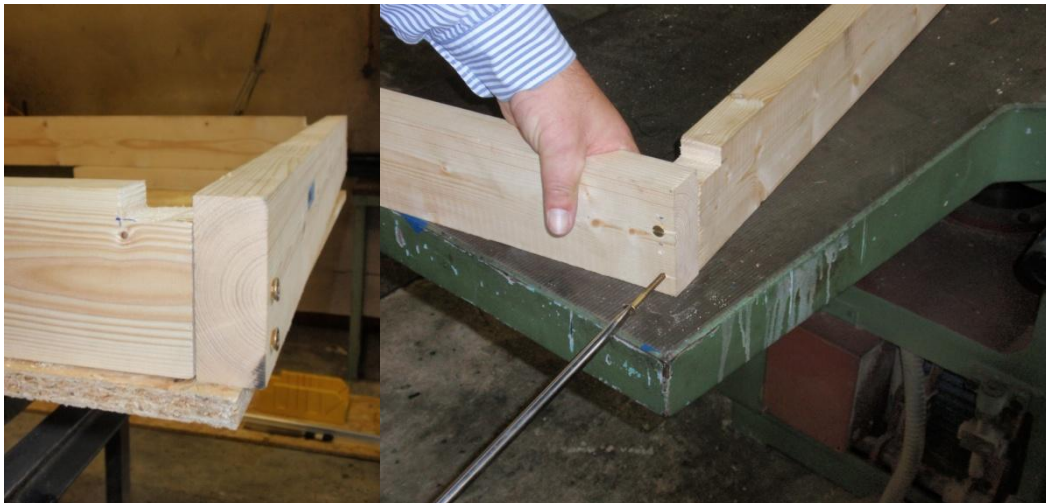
Pormenor de corte para perfil de alumínio e aparafusar
